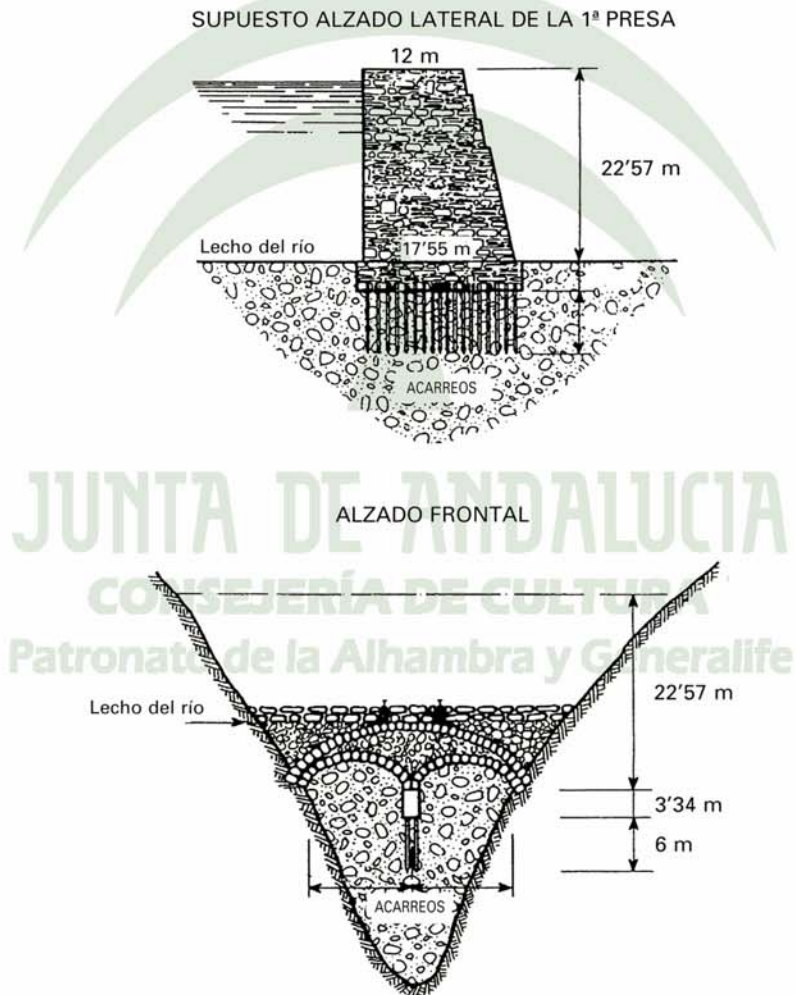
Alzados de la primera presa del Estrecho de Puentes (Bautista y Muñoz, 1986).
